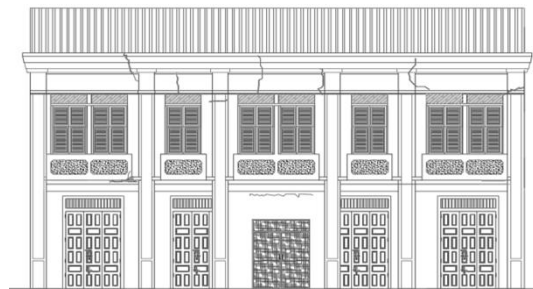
Levantamiento de la fachada frontal de la Casa Flor Cedeño. (INPC, 2017)
